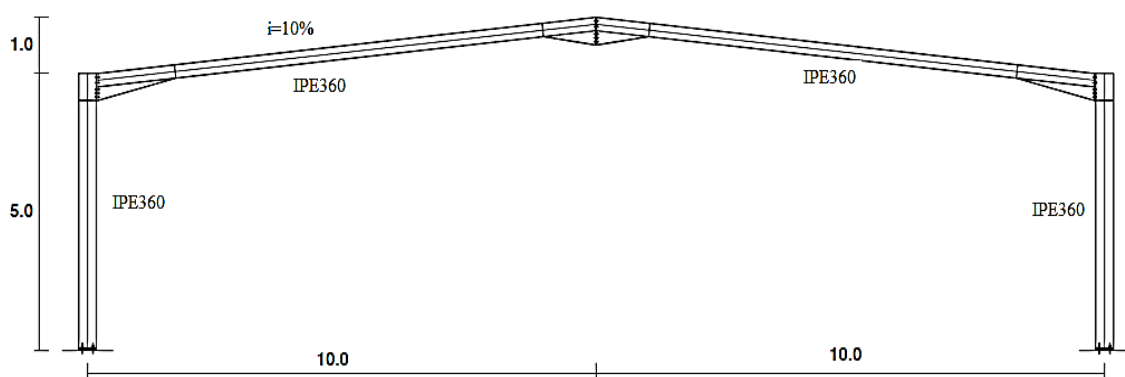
Principais características geométricas do pórtico metálico analisado
